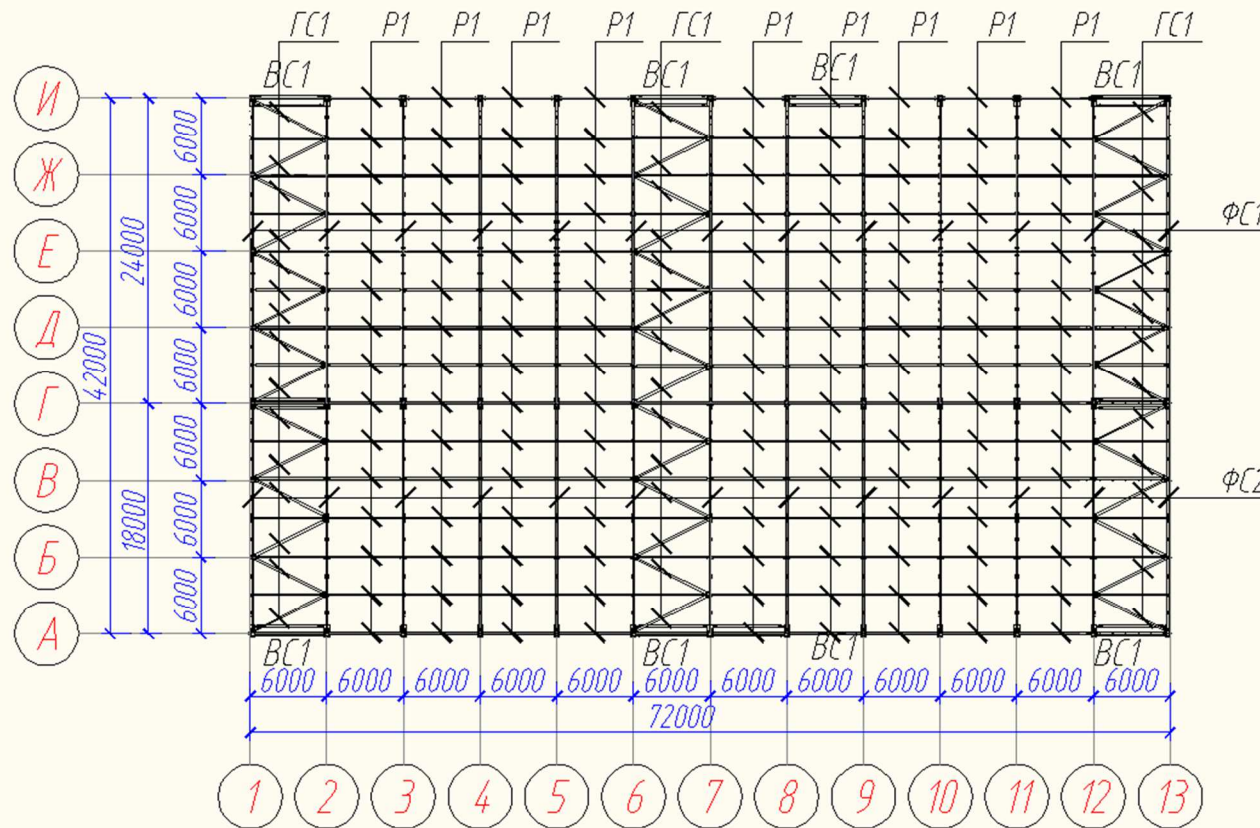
Схема расположения связей по верхним поясам стропильных ферм
